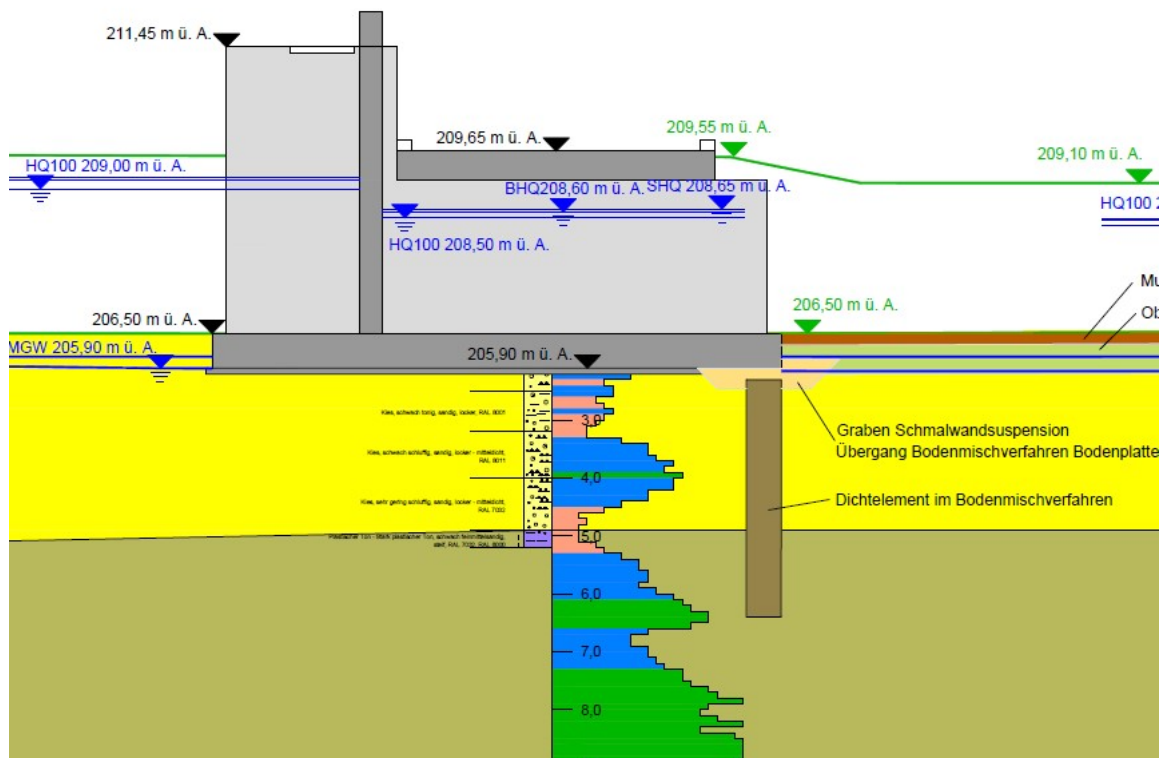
Schnitt durch das Dotationsbauwerk mit Dichtwand am nördlichen Rand des Bauwerkes ([13], Anlage 7, Beilage 1 des Geotechnischen Gutachtens)
